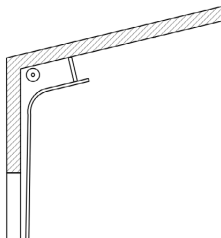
Наклонный высокий монтаж с верхним расположением вала
